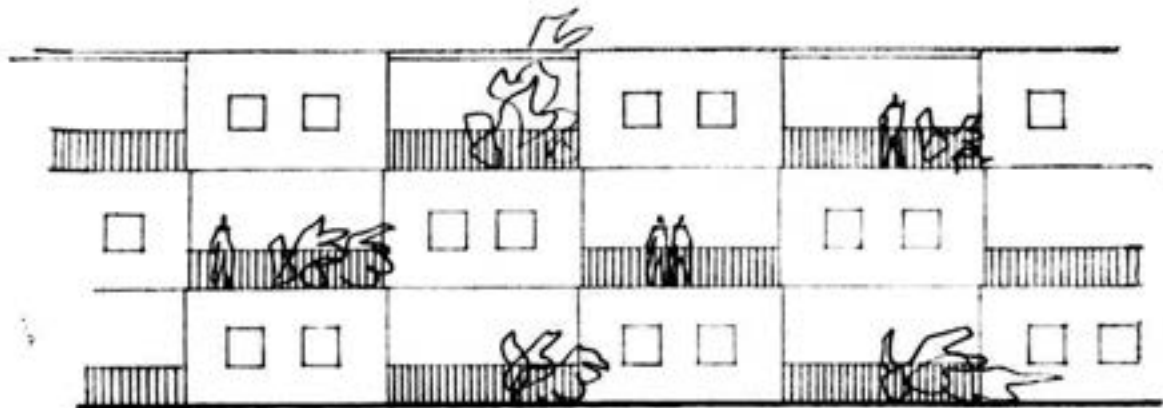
Fachada do conjunto vertical – fonte: (NIEMEYER, 1962 p. 36)
